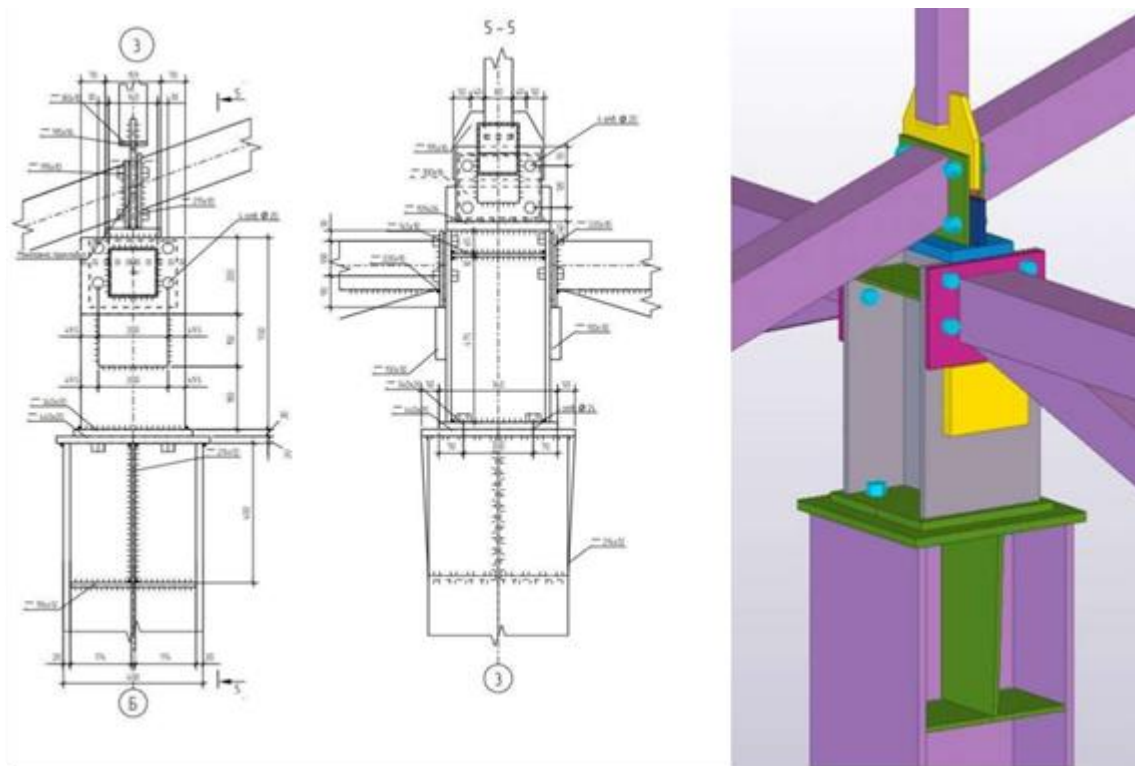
Вузол опирання підкрів'яних та кров'яних ферм на колону в ПК Tekla Structures
